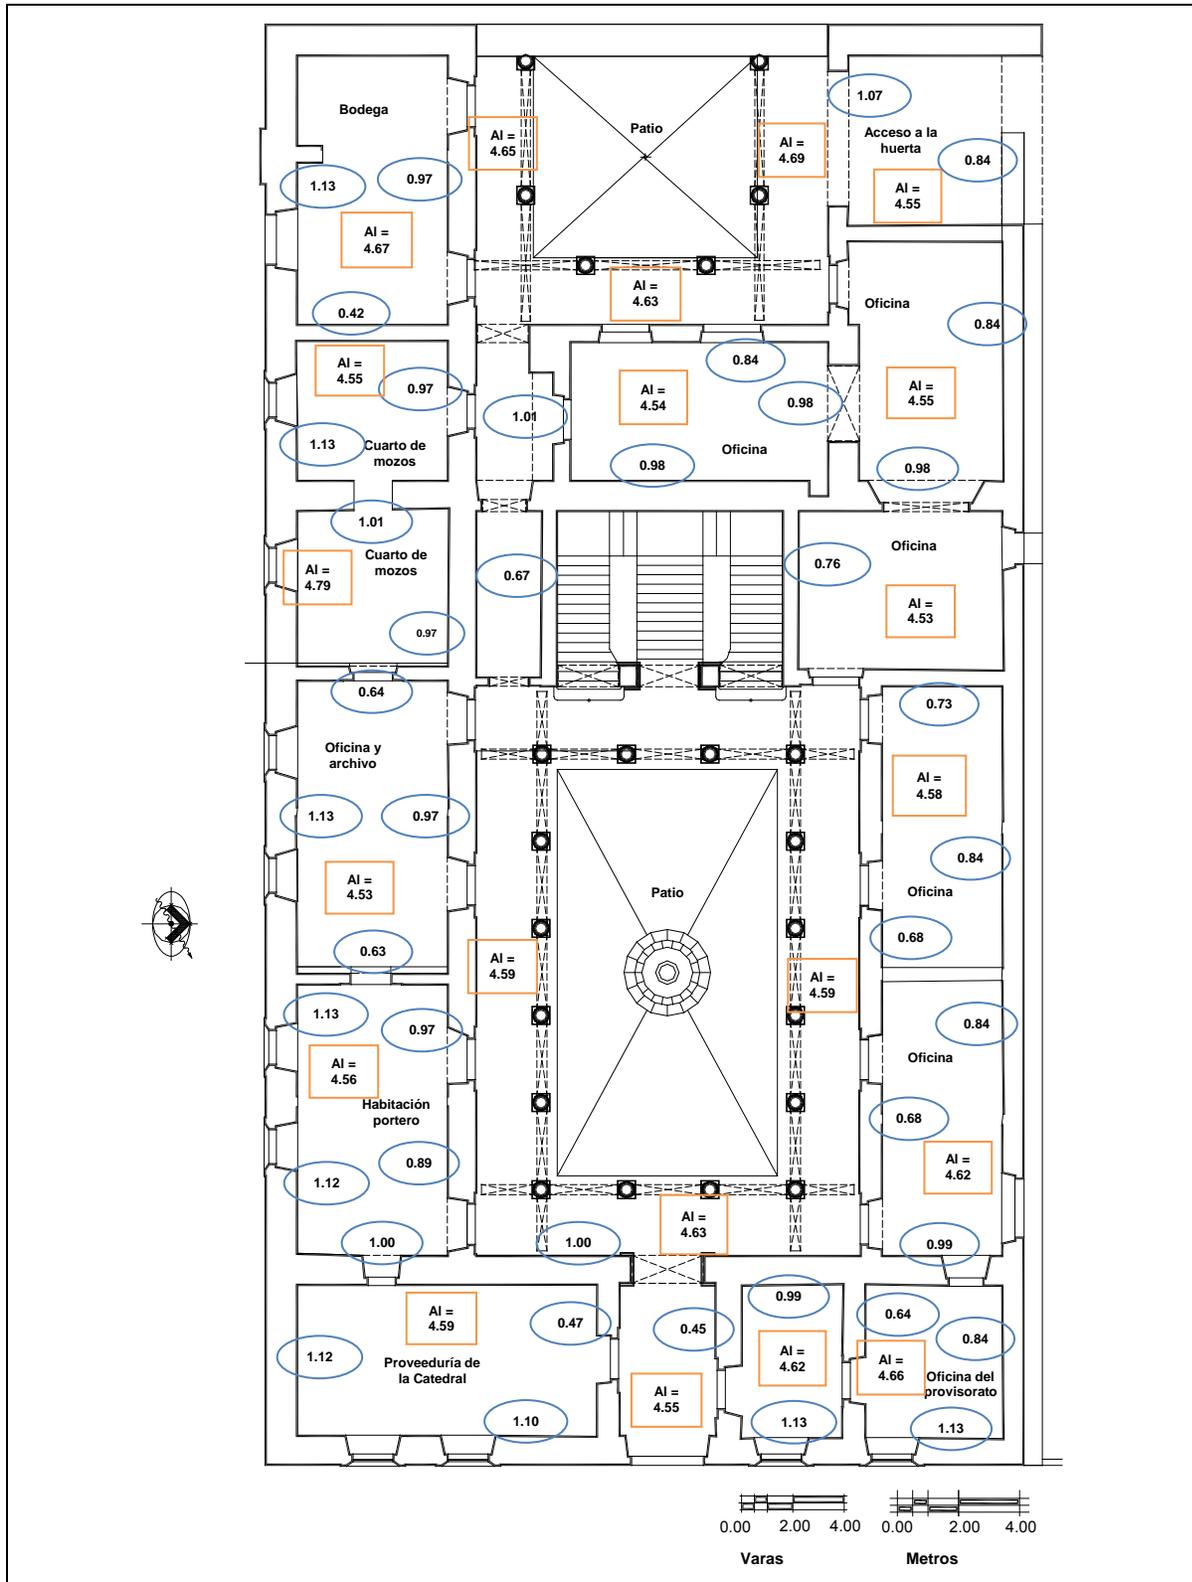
Espesores y altura de muros en Palacio Episcopal, actuales oficinas de la Secretaría de Salud del Estado de Michoacán, planta baja, en reconstrucción histórica del siglo XVIII.
